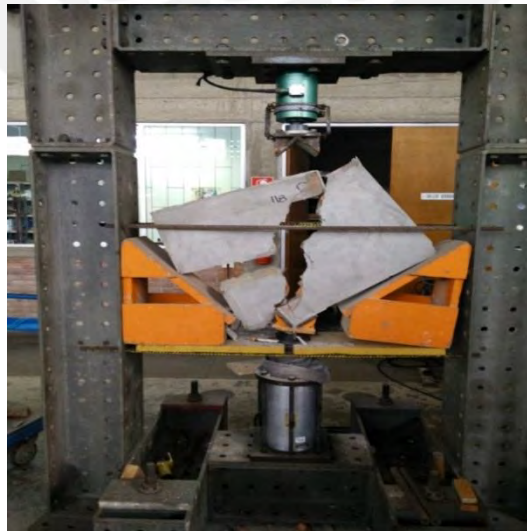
Falla por tracción diagonal de murete N° 2 (Tipo M1)
